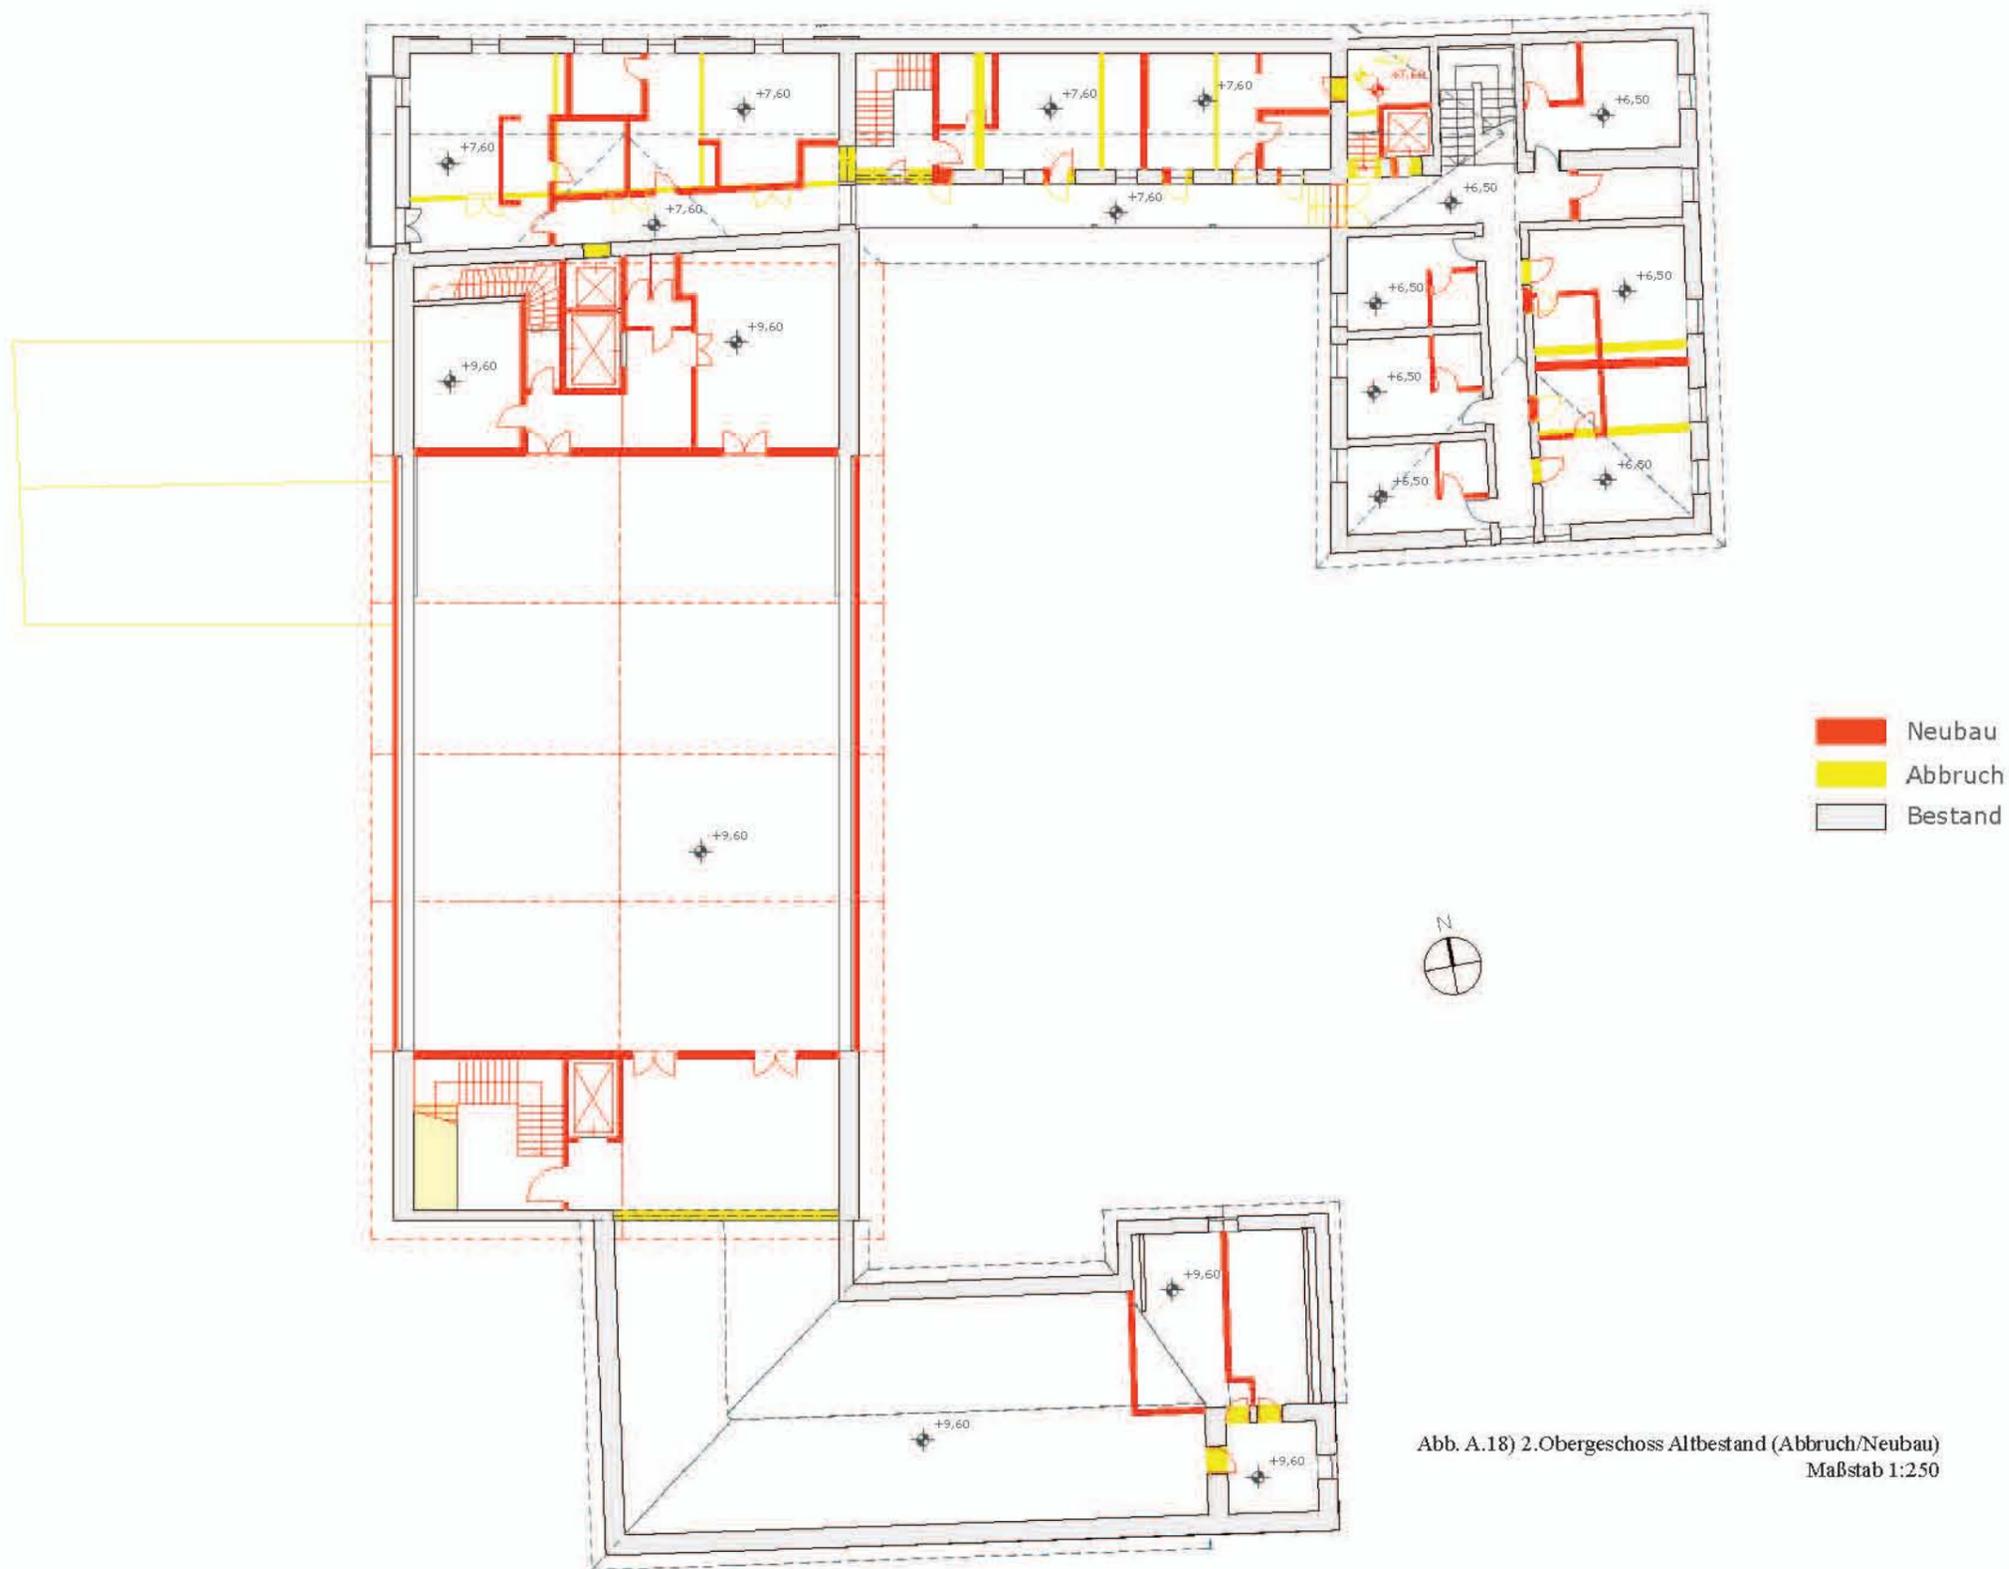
2.Obergeschoss Altbestand (Abbruch/Neubau)
